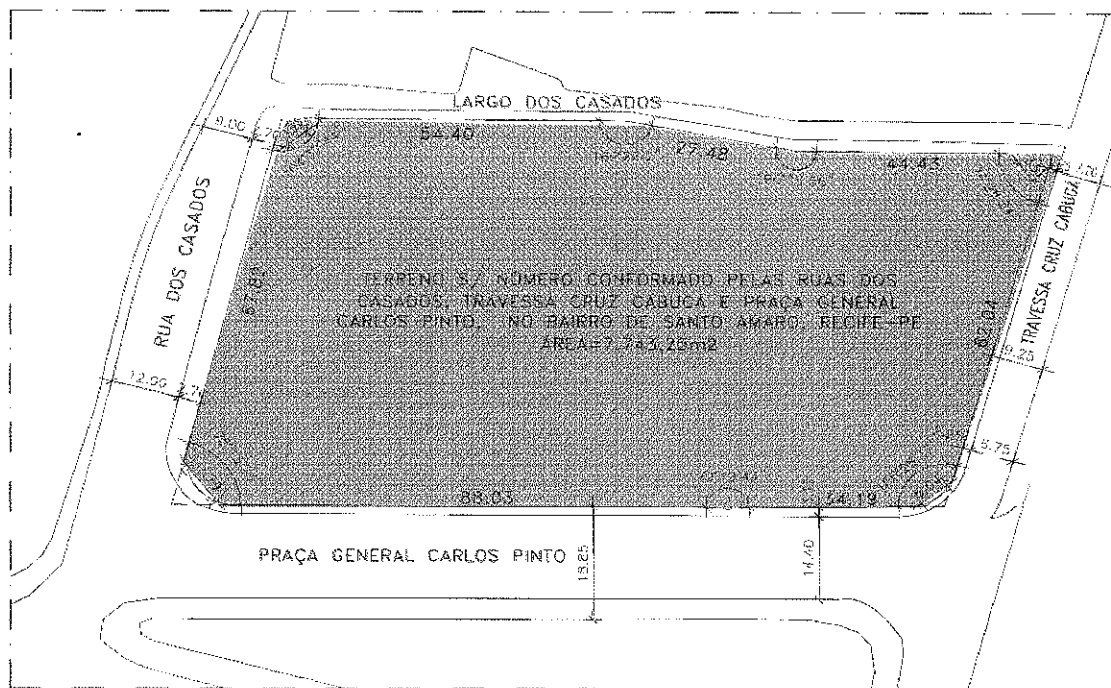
Planta de Situação do Empreendimento. fonte: Projeto Arquitetônico
